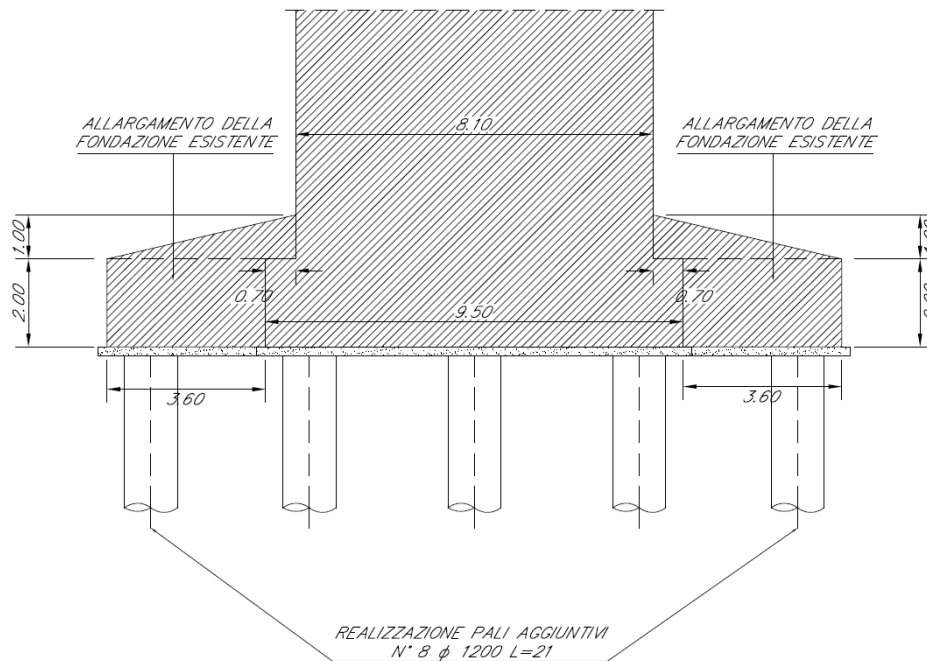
Sezione rappresentativa degli interventi di adeguamento sismico sulle fondazioni delle spalle
